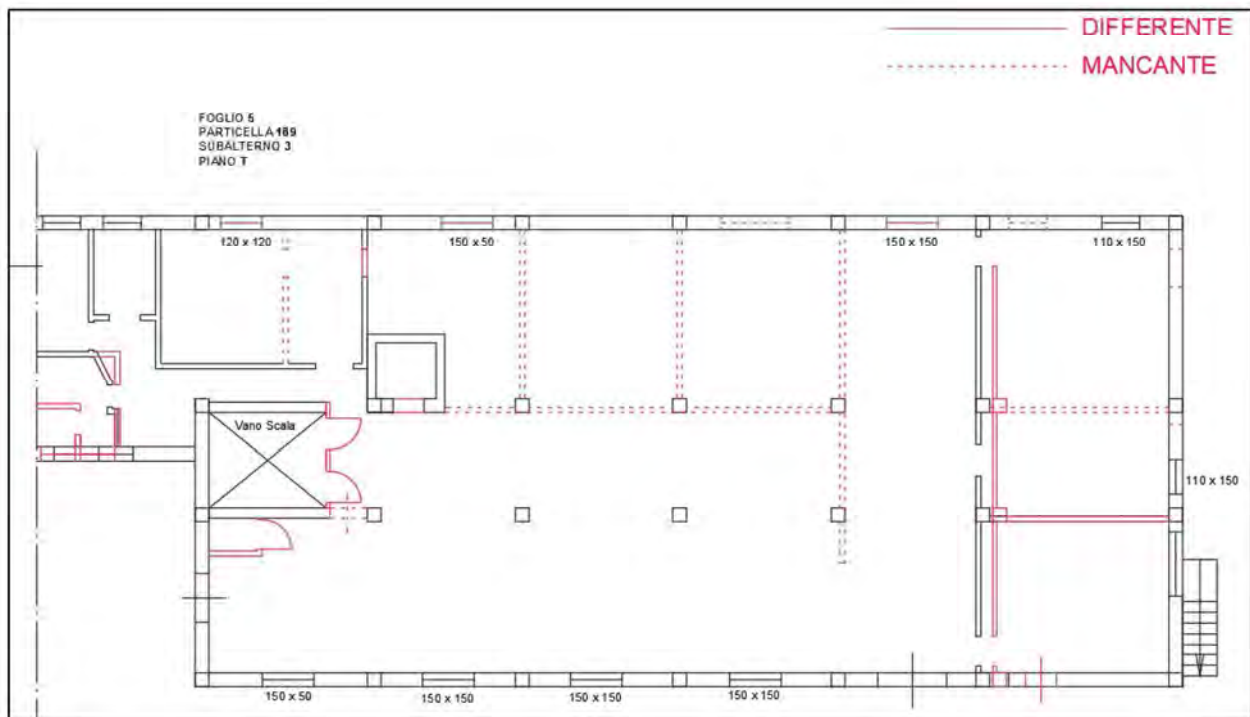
Planimetria piano terra - Difformità tra progetto in variante e stato di fatto rilevato durante il sopralluogo del 07.02.2019
